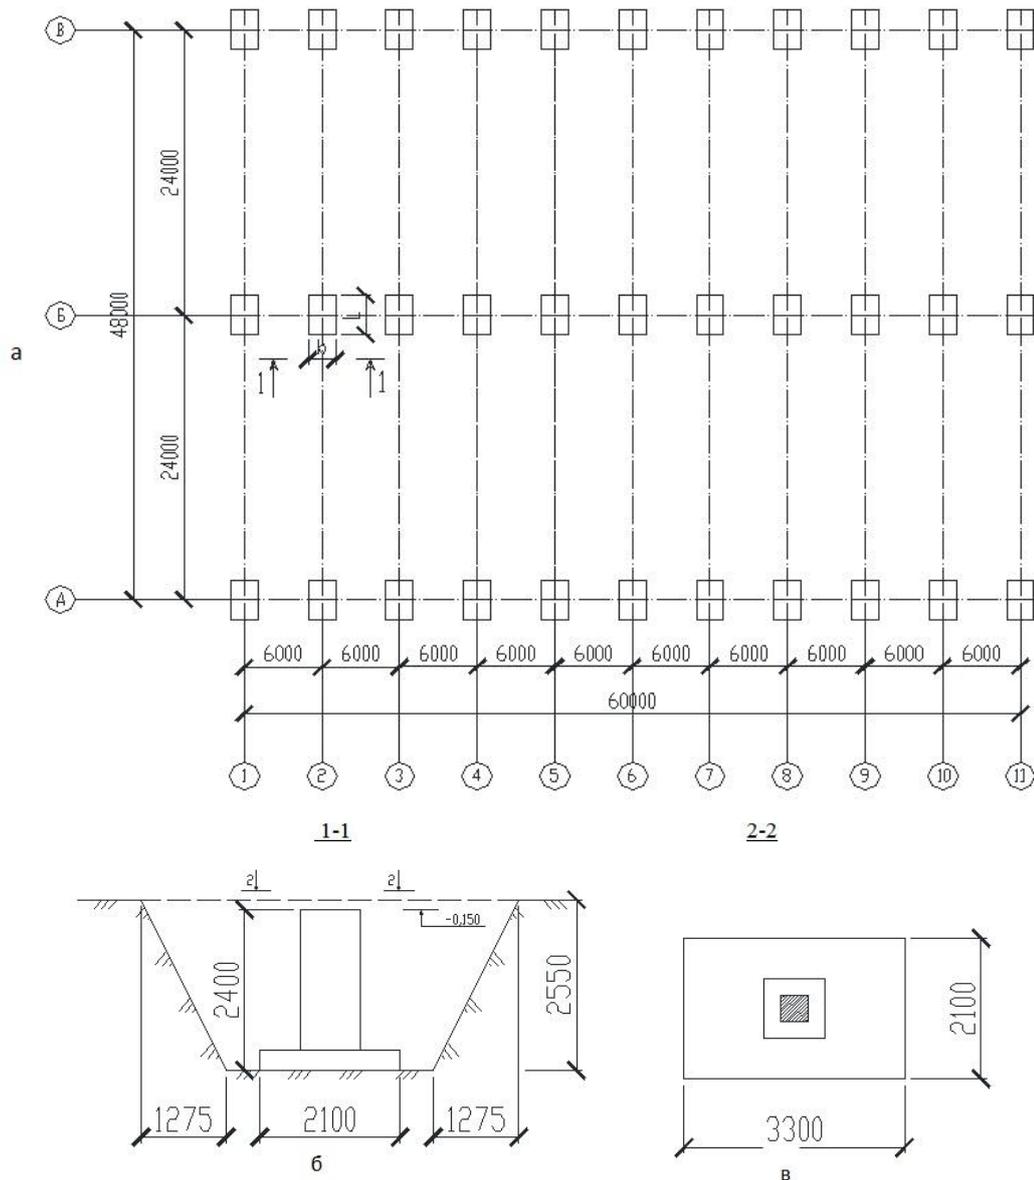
Чертеж плана фундаментов: а – план фундаментов;
